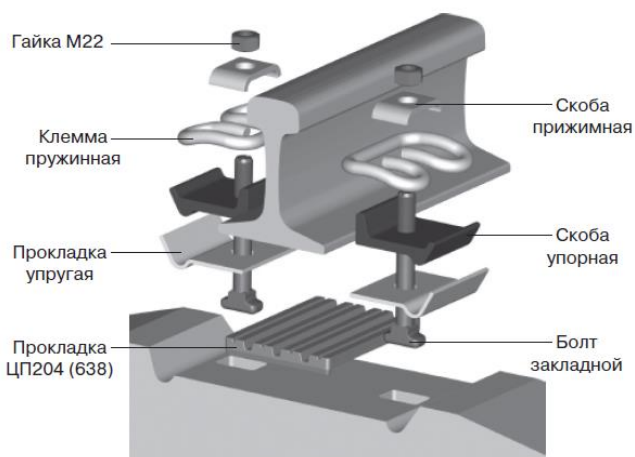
Общий вид конструкции крепления ЖБР-65
